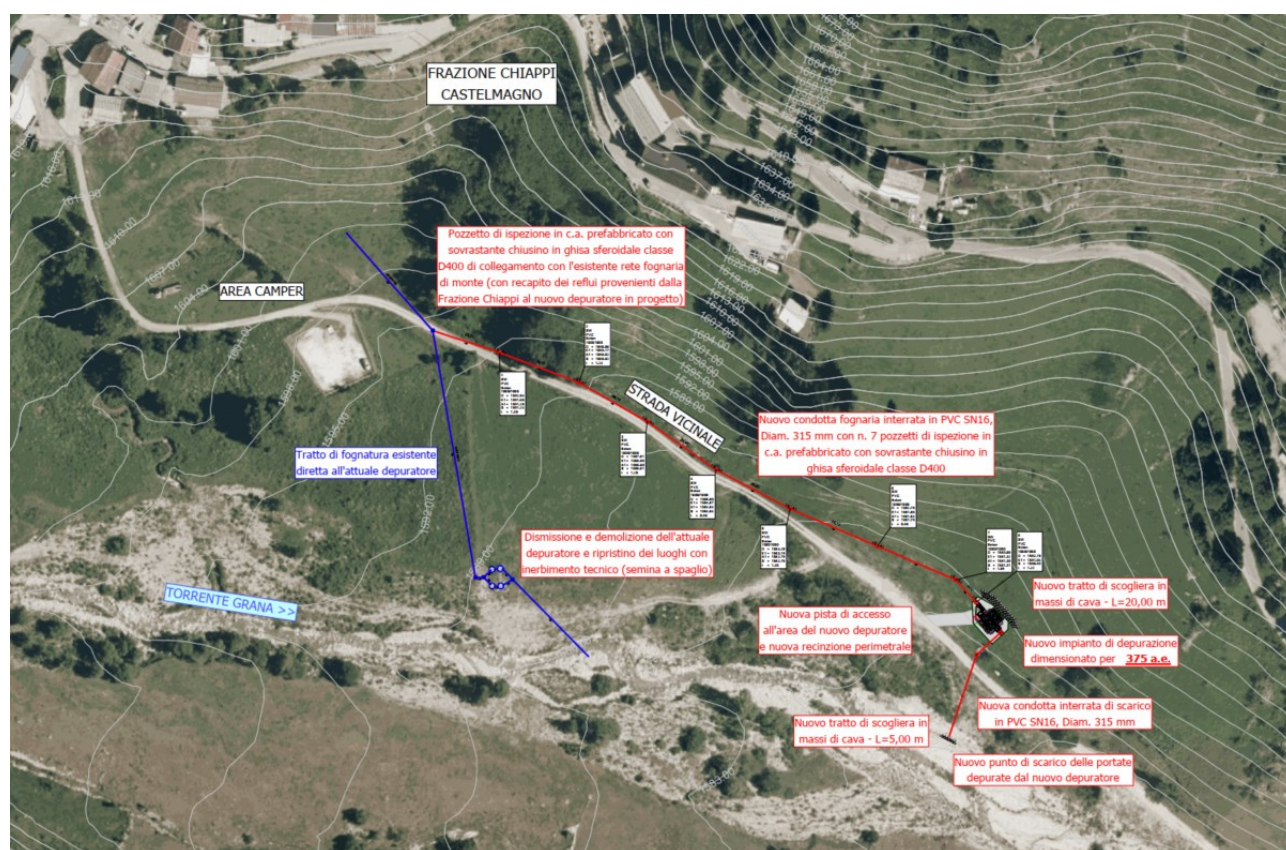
Planimetria di progetto su base ortofoto. Fuori scala.
